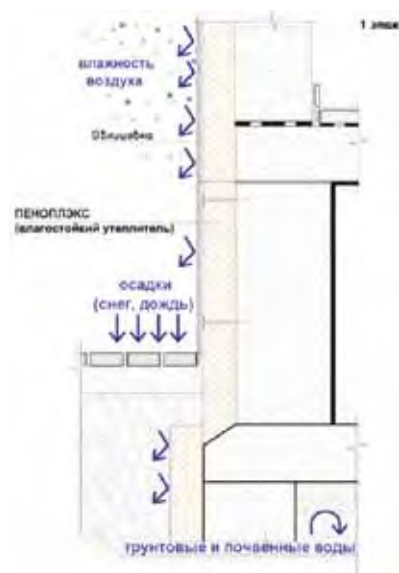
Схема теплоизоляции цокольного и первого этажа с применением плит ПЕНОПЛЭКС®
